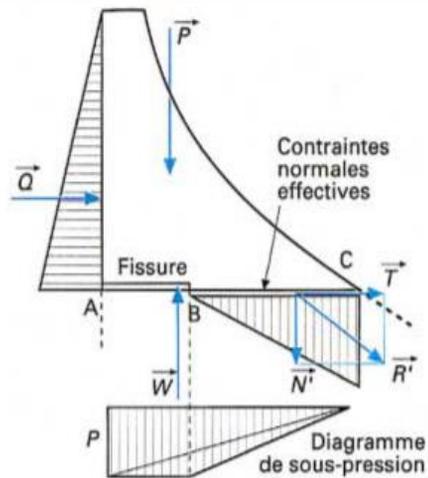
Équilibre avec fissuration (profil non drainé)
